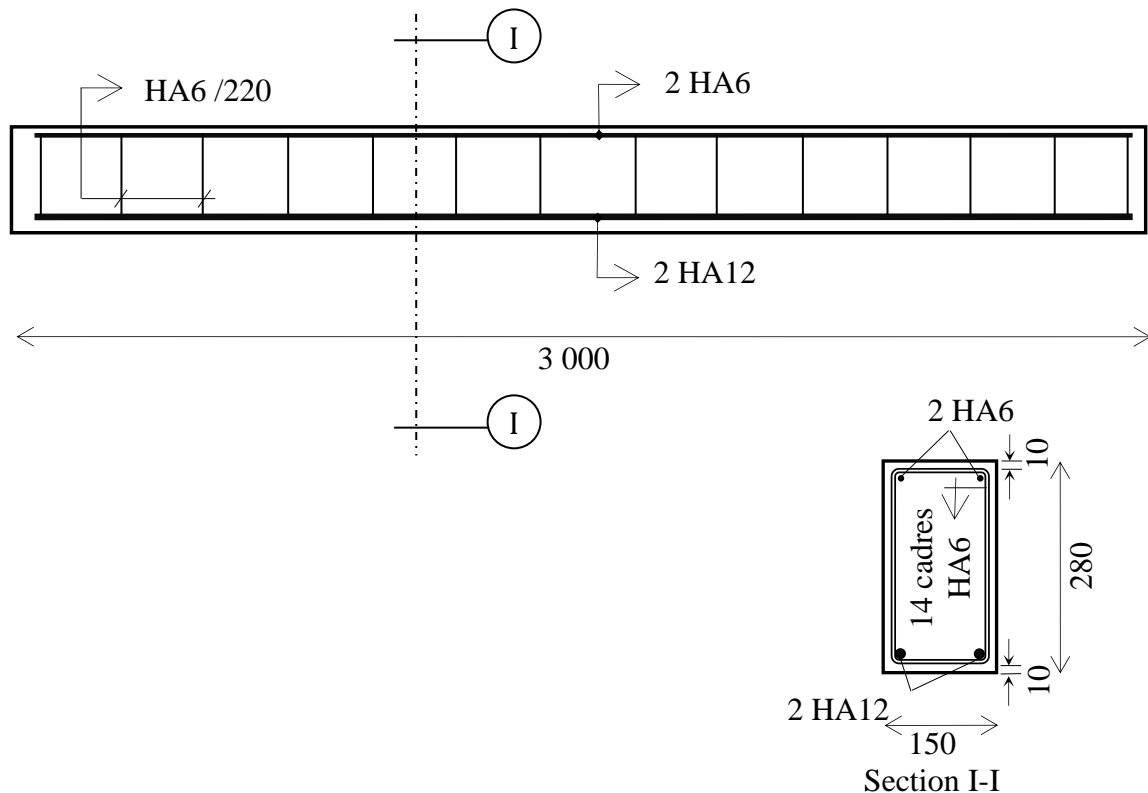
Plan de ferrailage des poutres de type B (toutes les dimensions en mm).
